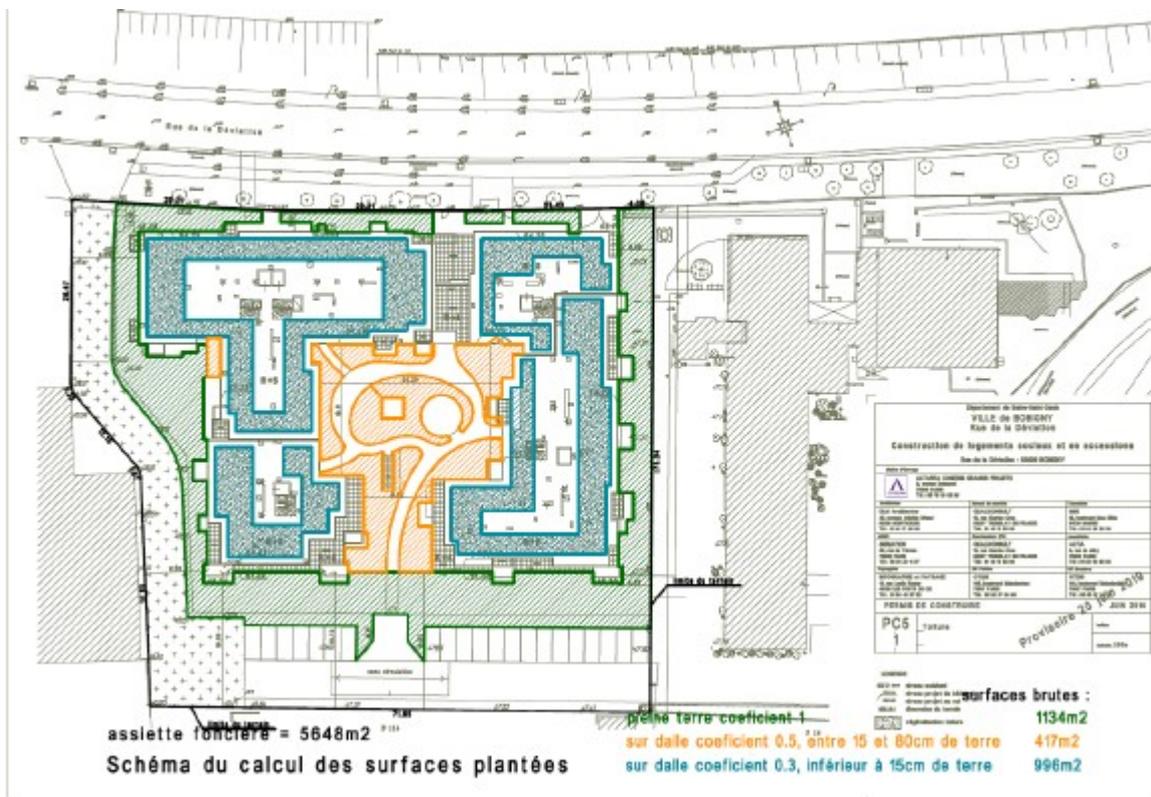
Plan masse du projet – source : étude d'impact (p.160)
